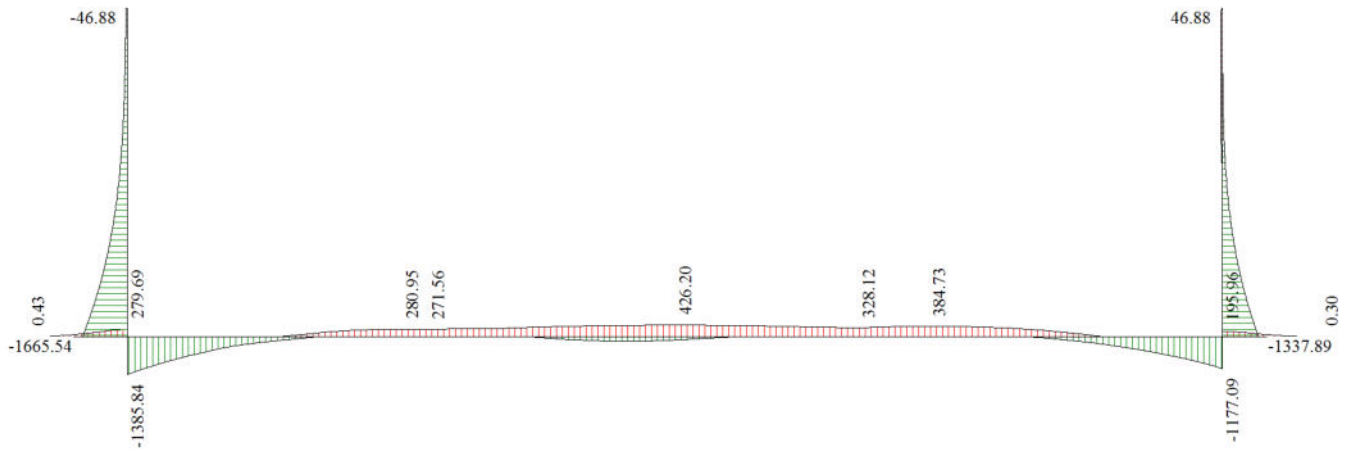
Sezione 2.A - SLU - Inviluppo azione flettente
